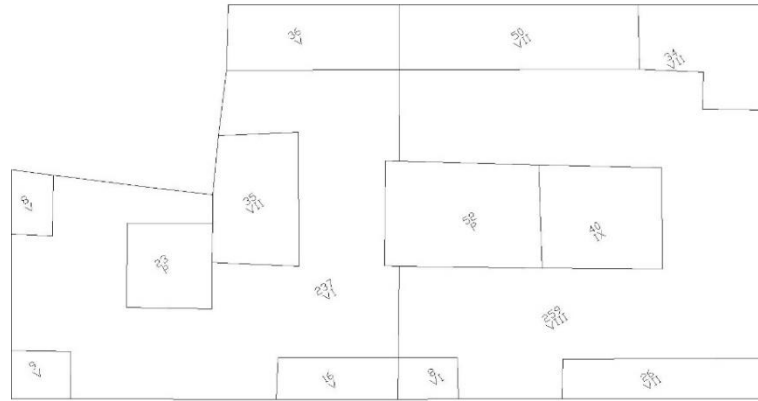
Plano de edificio de viviendas (Puerto de Sagunto).
